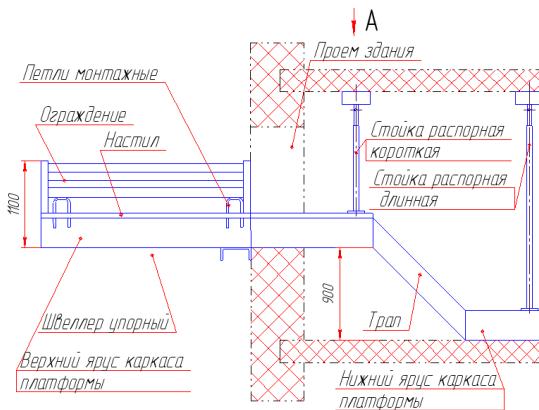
Схема конструктивного решения выносной грузоприемной площадки, устанавливаемой в оконный проем
